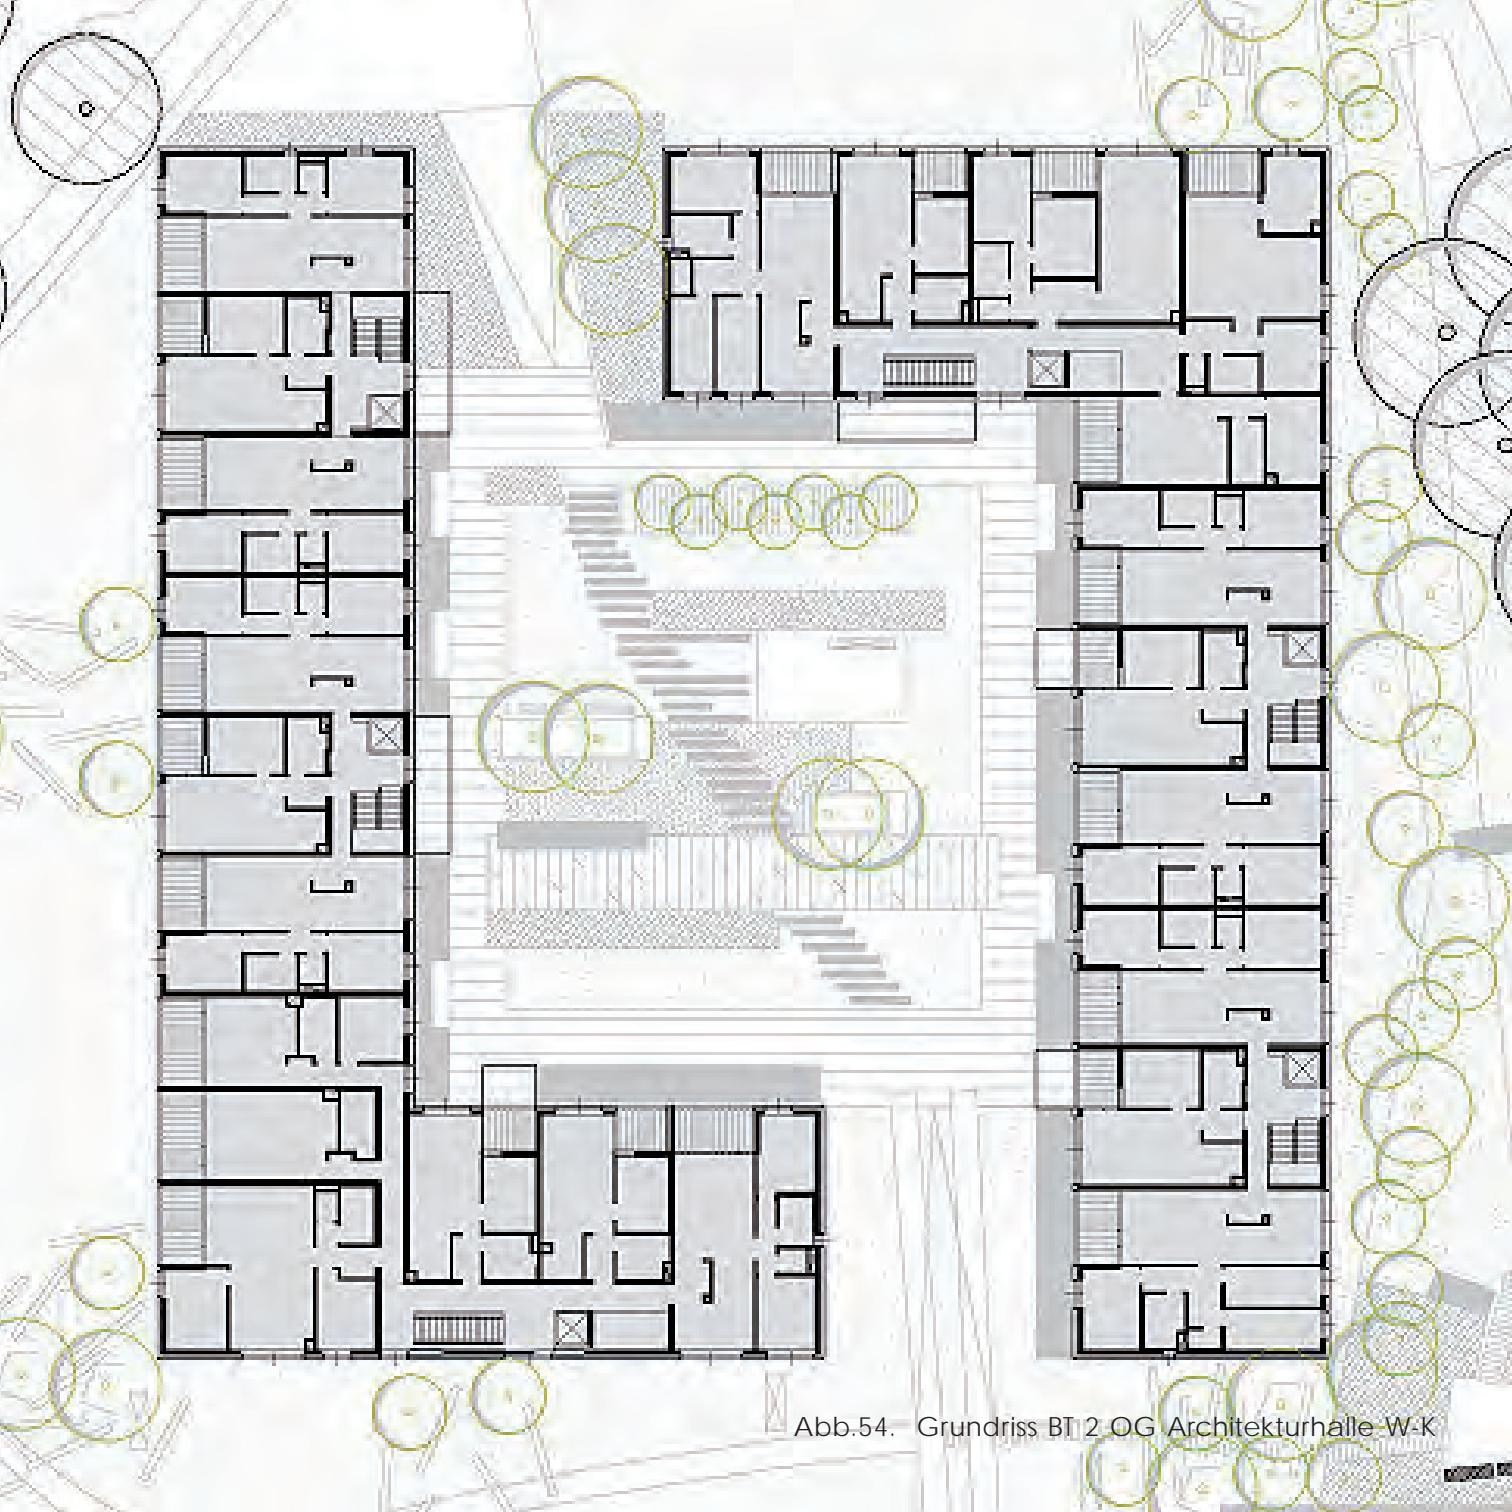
Grundriss BT 2 OG Architekturhalle-W-K
